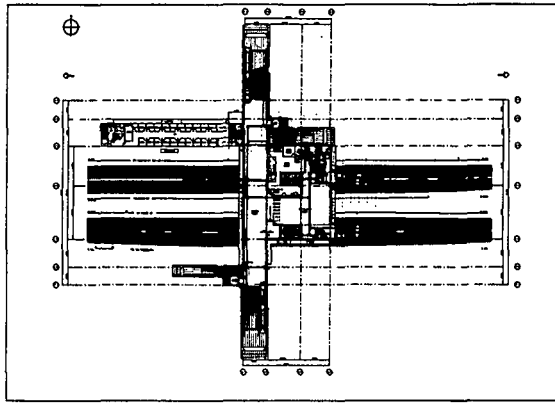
自由通路部と駅施設部の概要図その2 (平面図)
